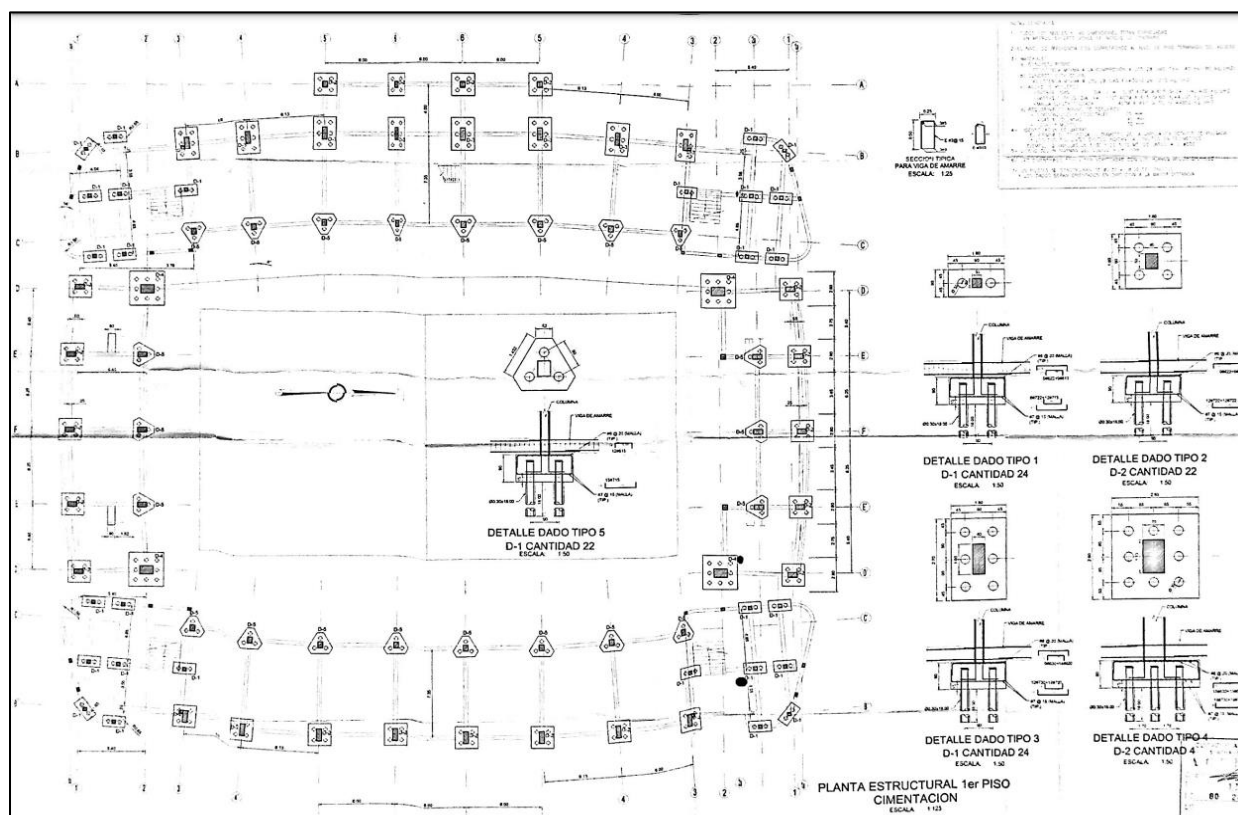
Planta Estructural Cimentación Pilotes con Dado cabecal.
